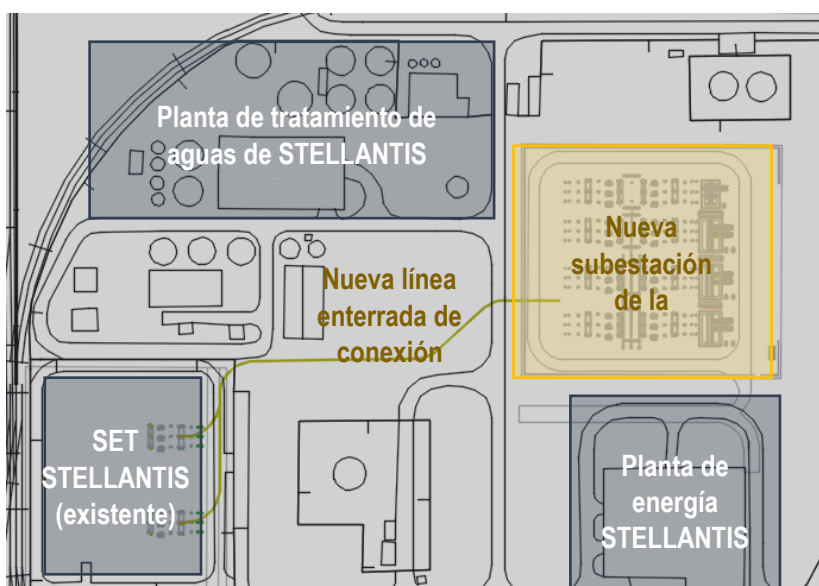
ubicación de la nueva subestación y línea enterrada dentro del ámbito de la planta de STELLANTIS.
